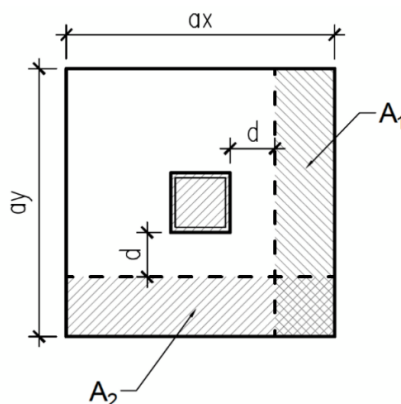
Secciones críticas, verificación al corte como viga ancha.
